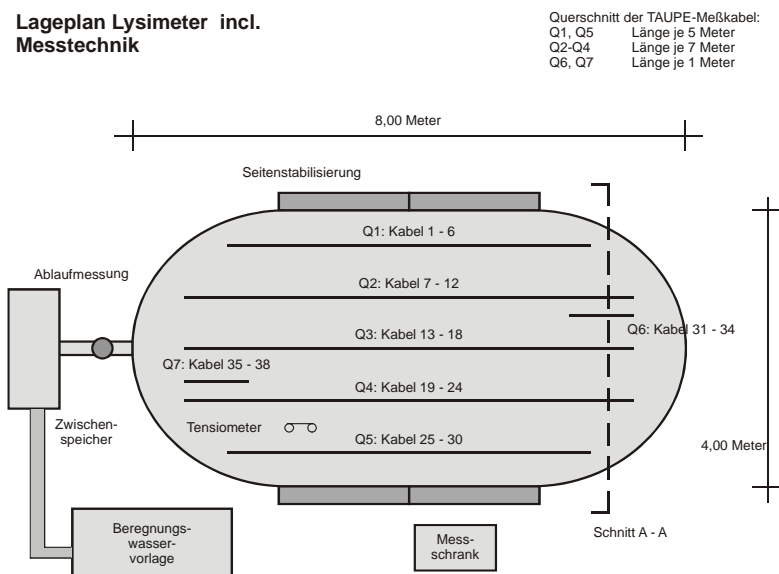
Lageplan des Lysimeters einschließlich der Messtechnik
